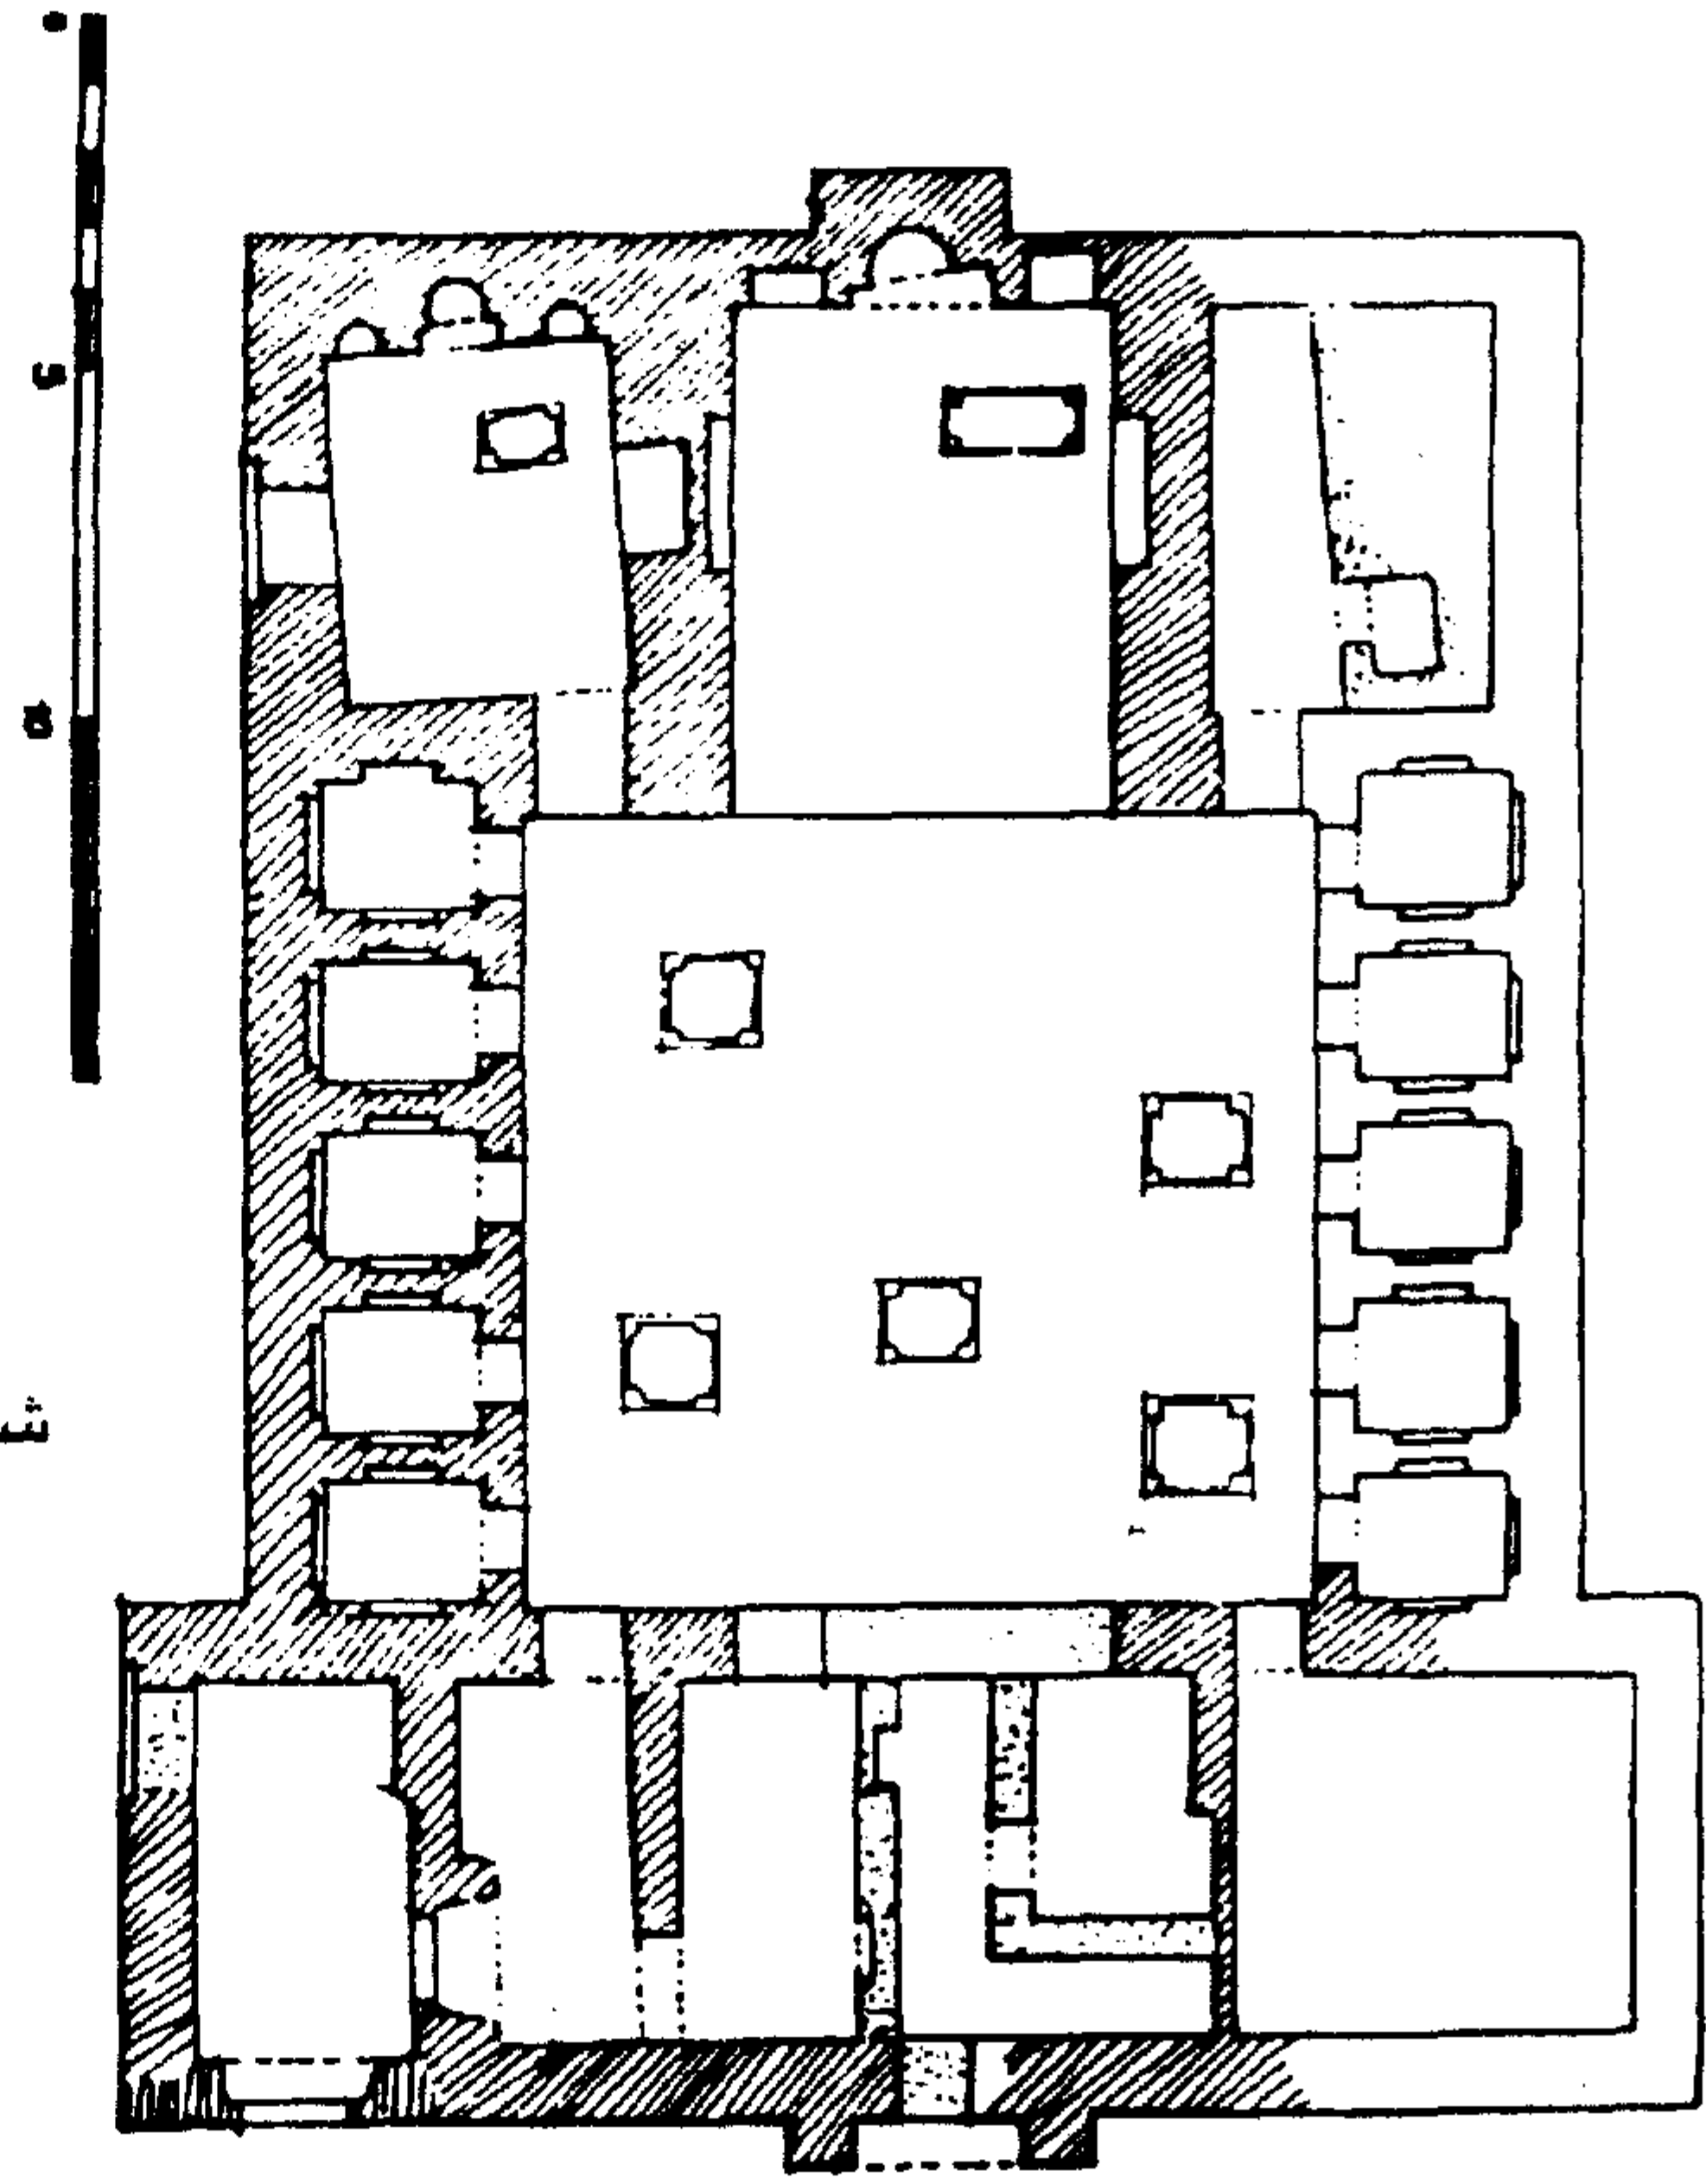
مسقط أفقي لمدرسة ابن العديم بحلب.
